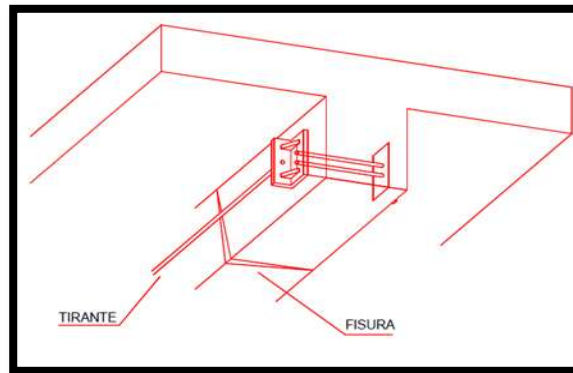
Reparación de la viga por sistemas atirantados.
